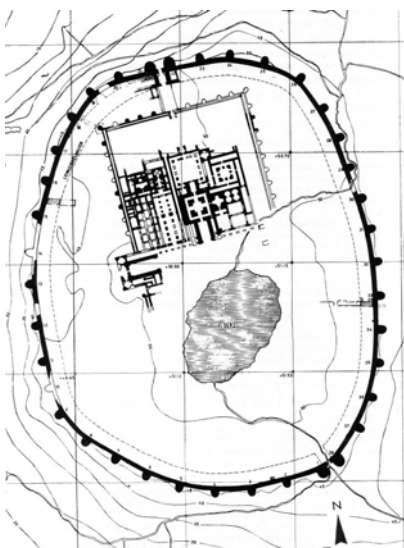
Grundriss Taht-i Sulaimān
